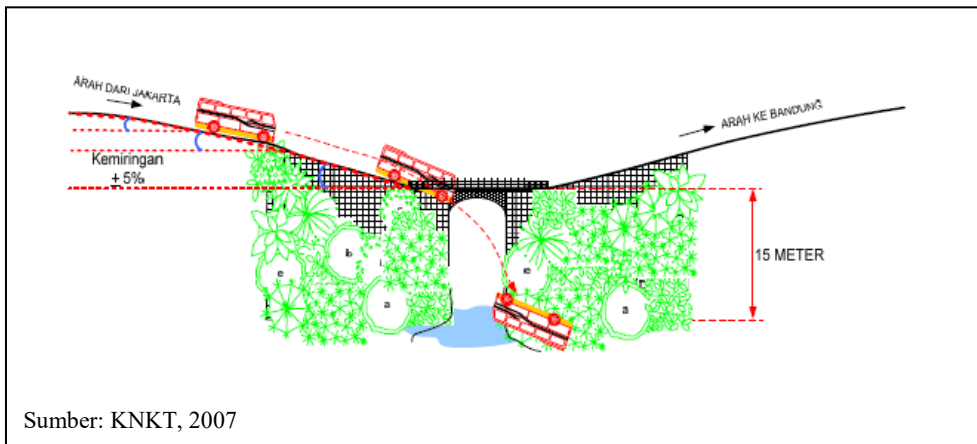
Geometrik dan Lingkungan Ruas Jalan Raya Puncak Ciloto
